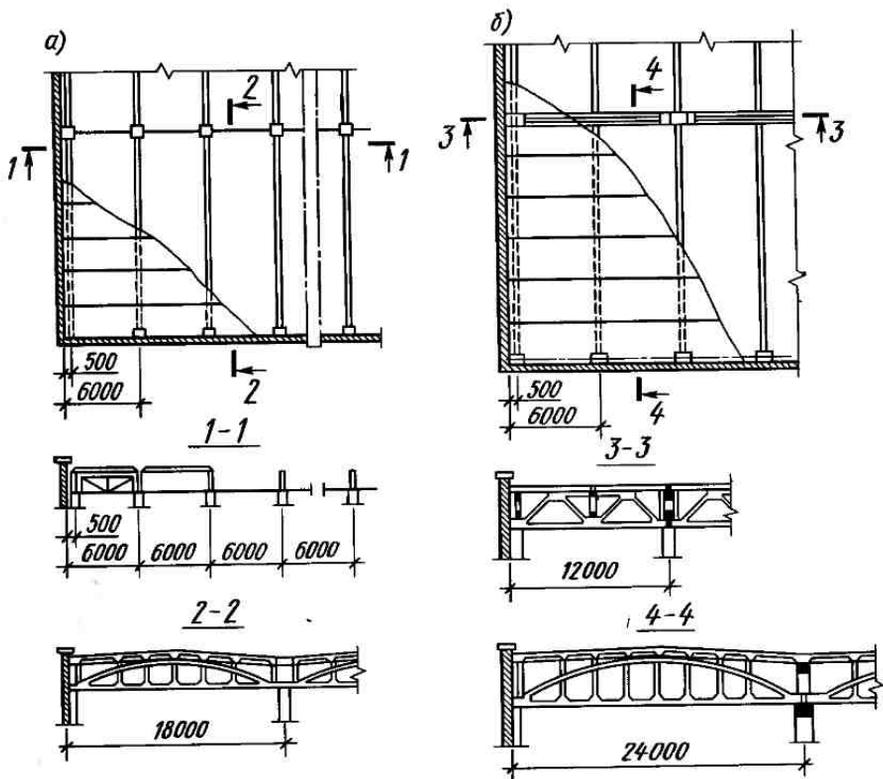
Конструктивные схемы одноэтажного промышленного здания: а — с шагом колонн 6 м, б — то же, с подстропильными конструкциями при шаге крайних колонн 6 м
